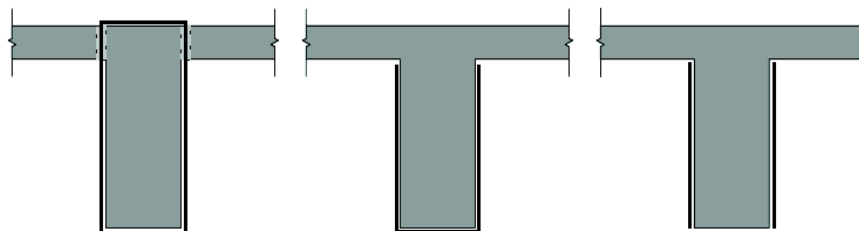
Configurações do reforço ao cisalhamento de vigas de concreto armado.
